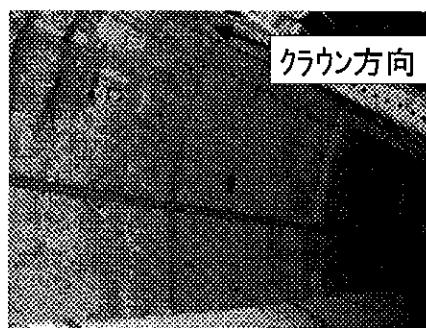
シールド洞道が変形してひび割れが発生している状況
